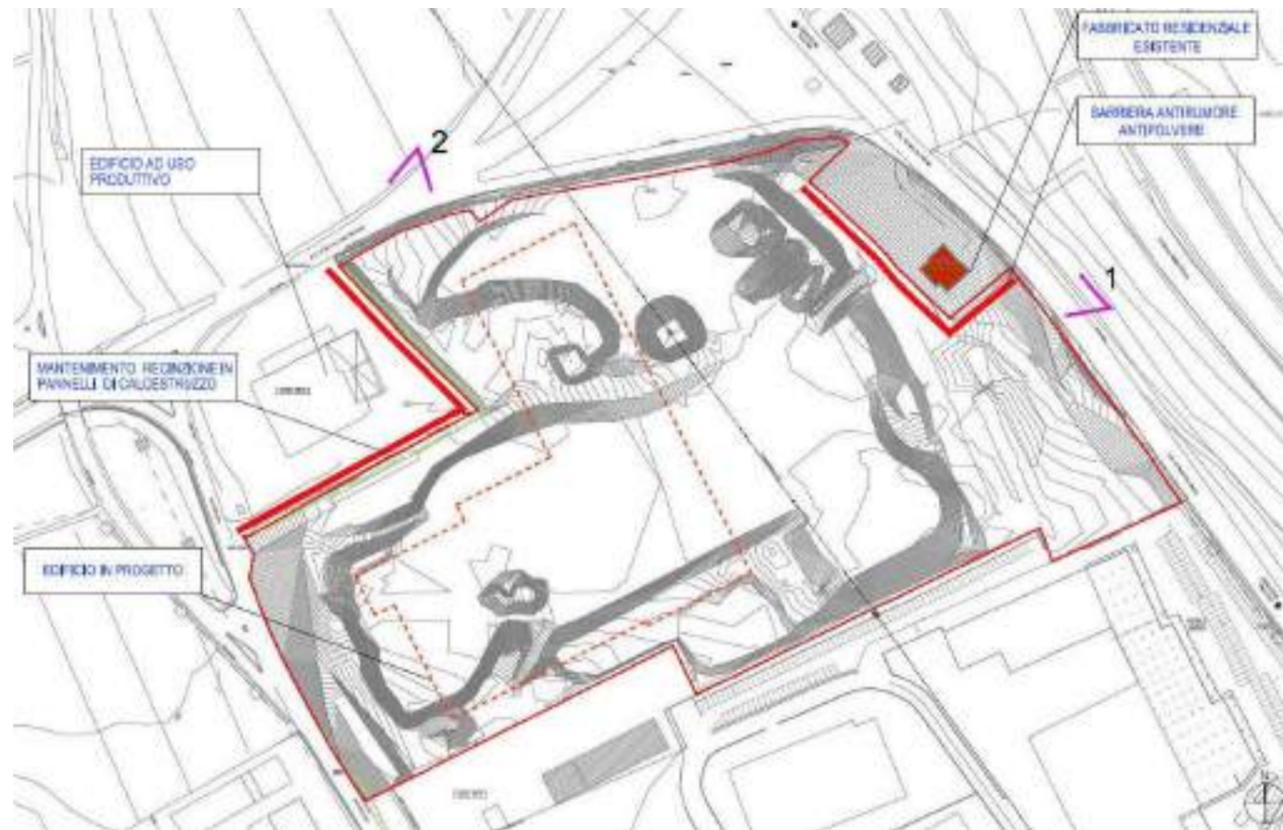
schema planimetrico con indicazione dell'area di cantiere, dei coni di ripresa delle foto precedenti e delle barriere provvisionali di mitigazione previste.
